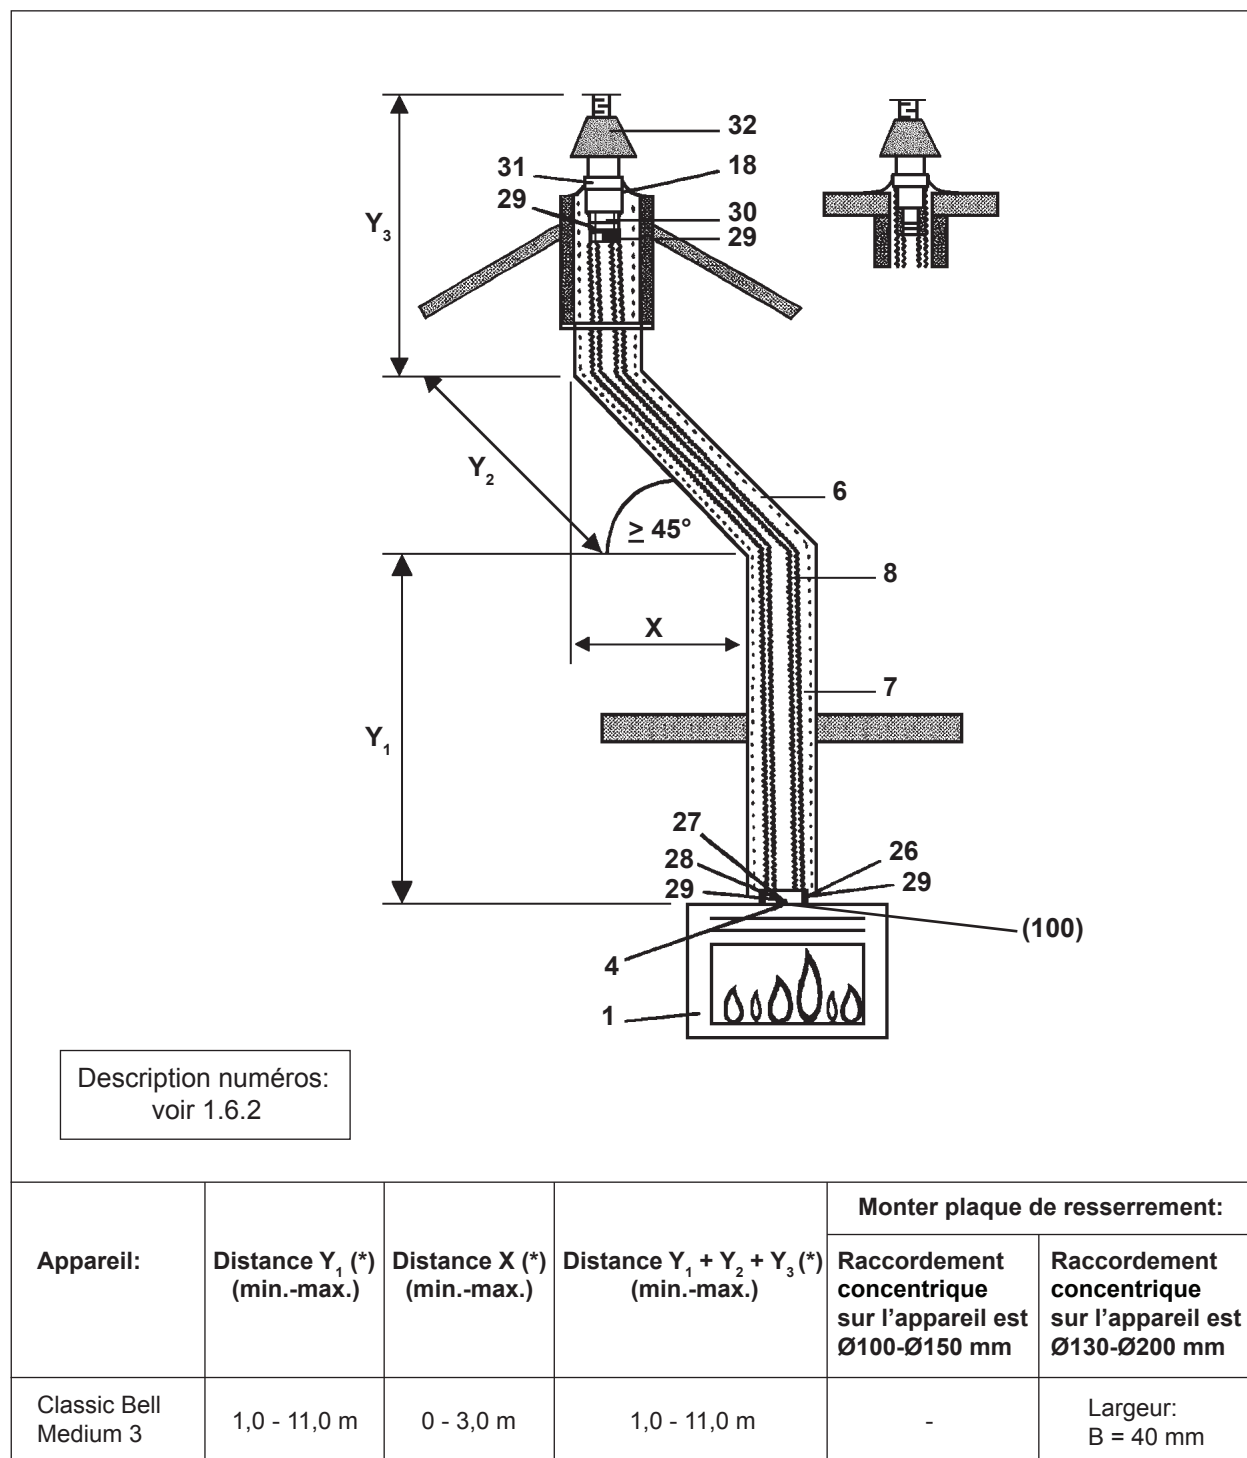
Sortie pour cheminée verticale en utilisant un conduit de fumée “fuite” existant ou si un conduit de fumée n’est pas présent
